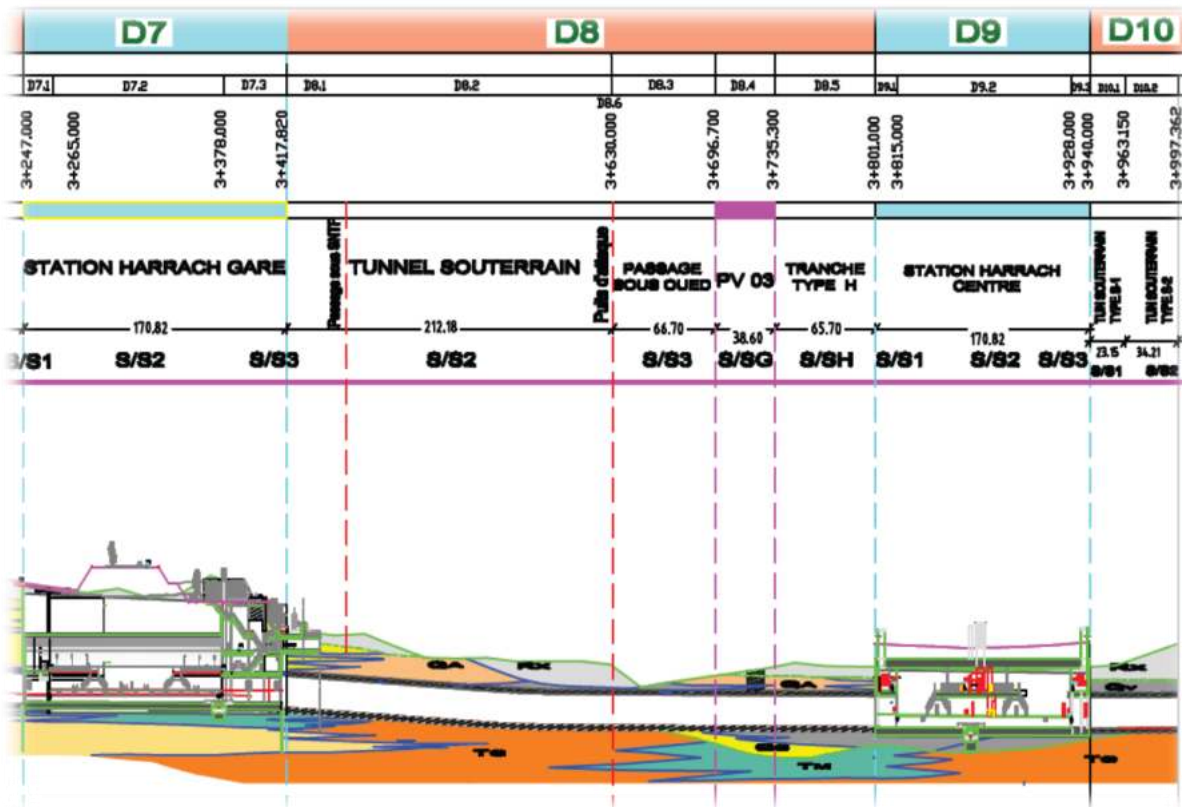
Implantation de l'ouvrage-coupe longitudinale
